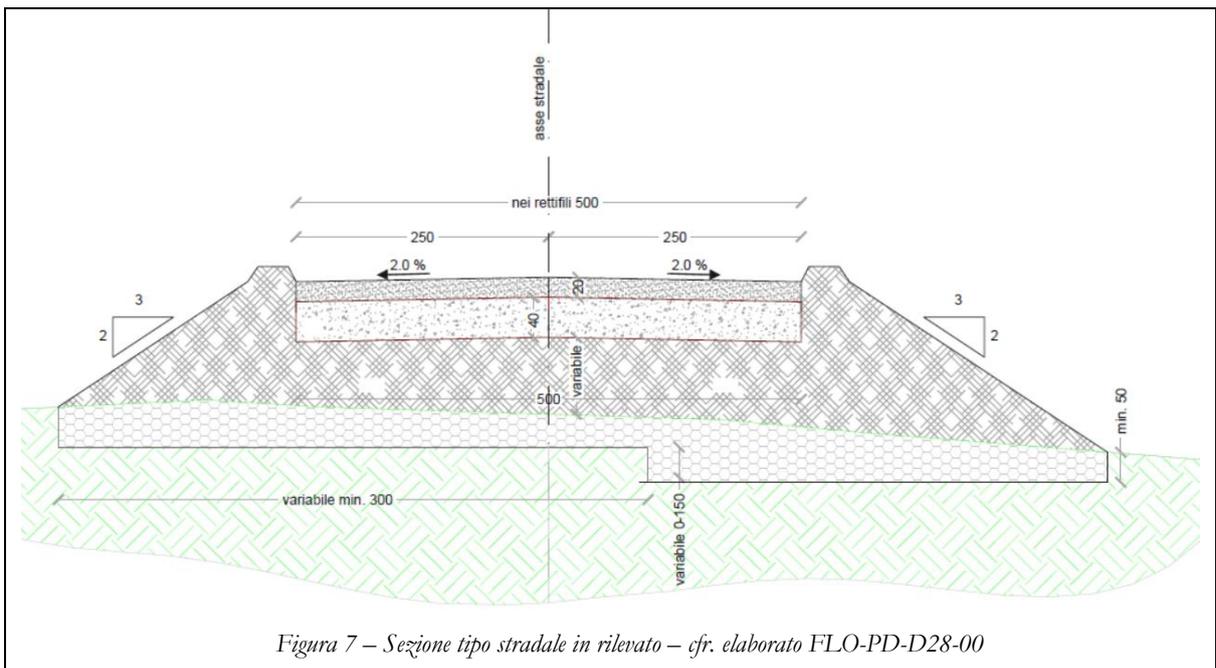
Sezione tipo stradale in rilevato – cfr. elaborato FLO-PD-D28-00
